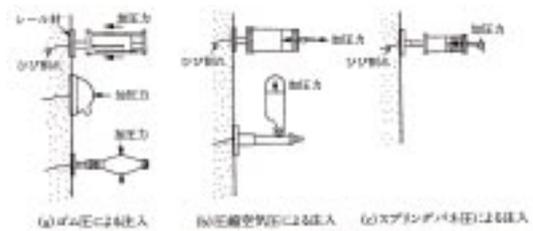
ひび割れ補修工法（注入工法）の例
